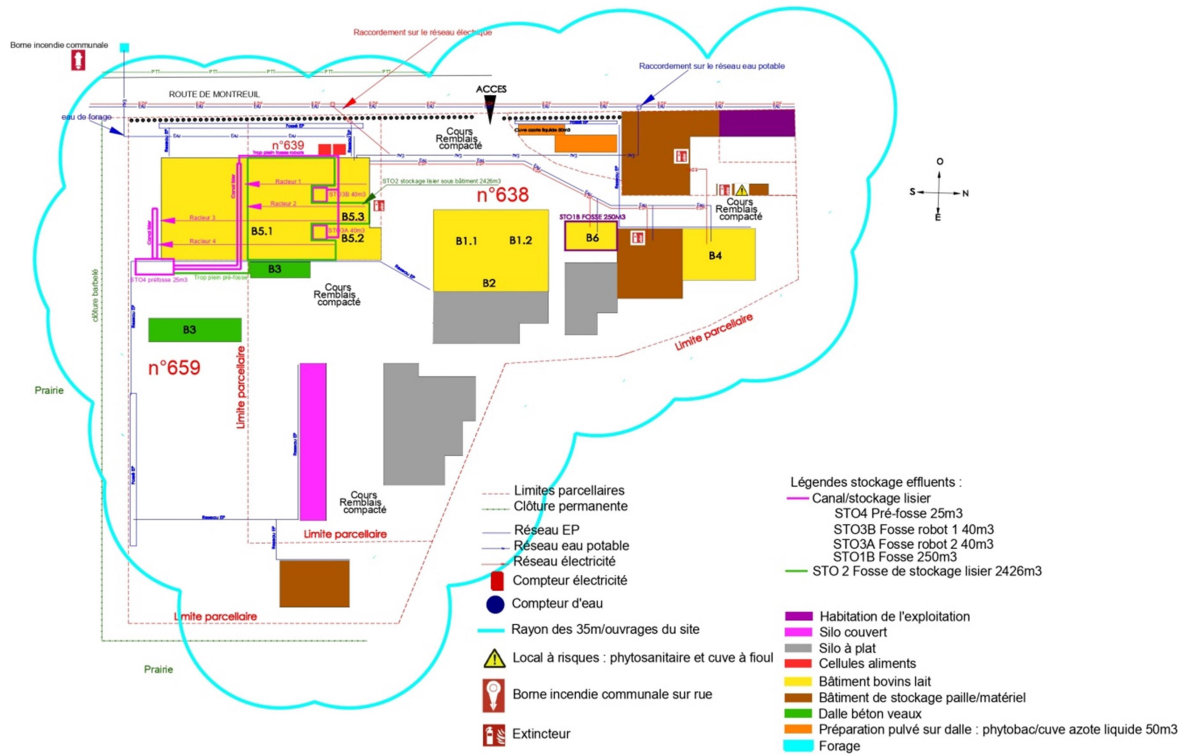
PLAN SITE DE VILLERS SUR AUTHIE
